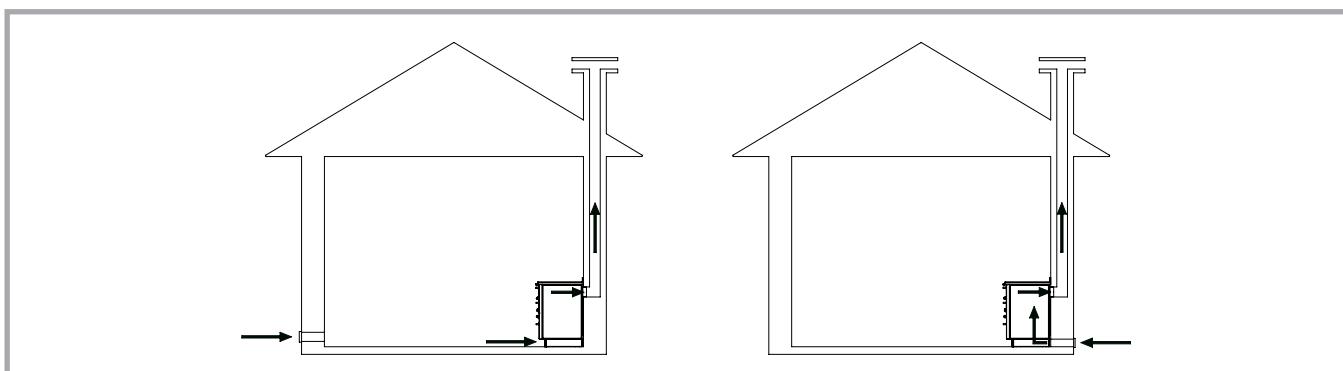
Installation des Herdes mit Luftzufuhr aus dem Aufstellungsraum und Installation mit externer Frischluftzufuhr, direkter Anschluss am Holzherd.
